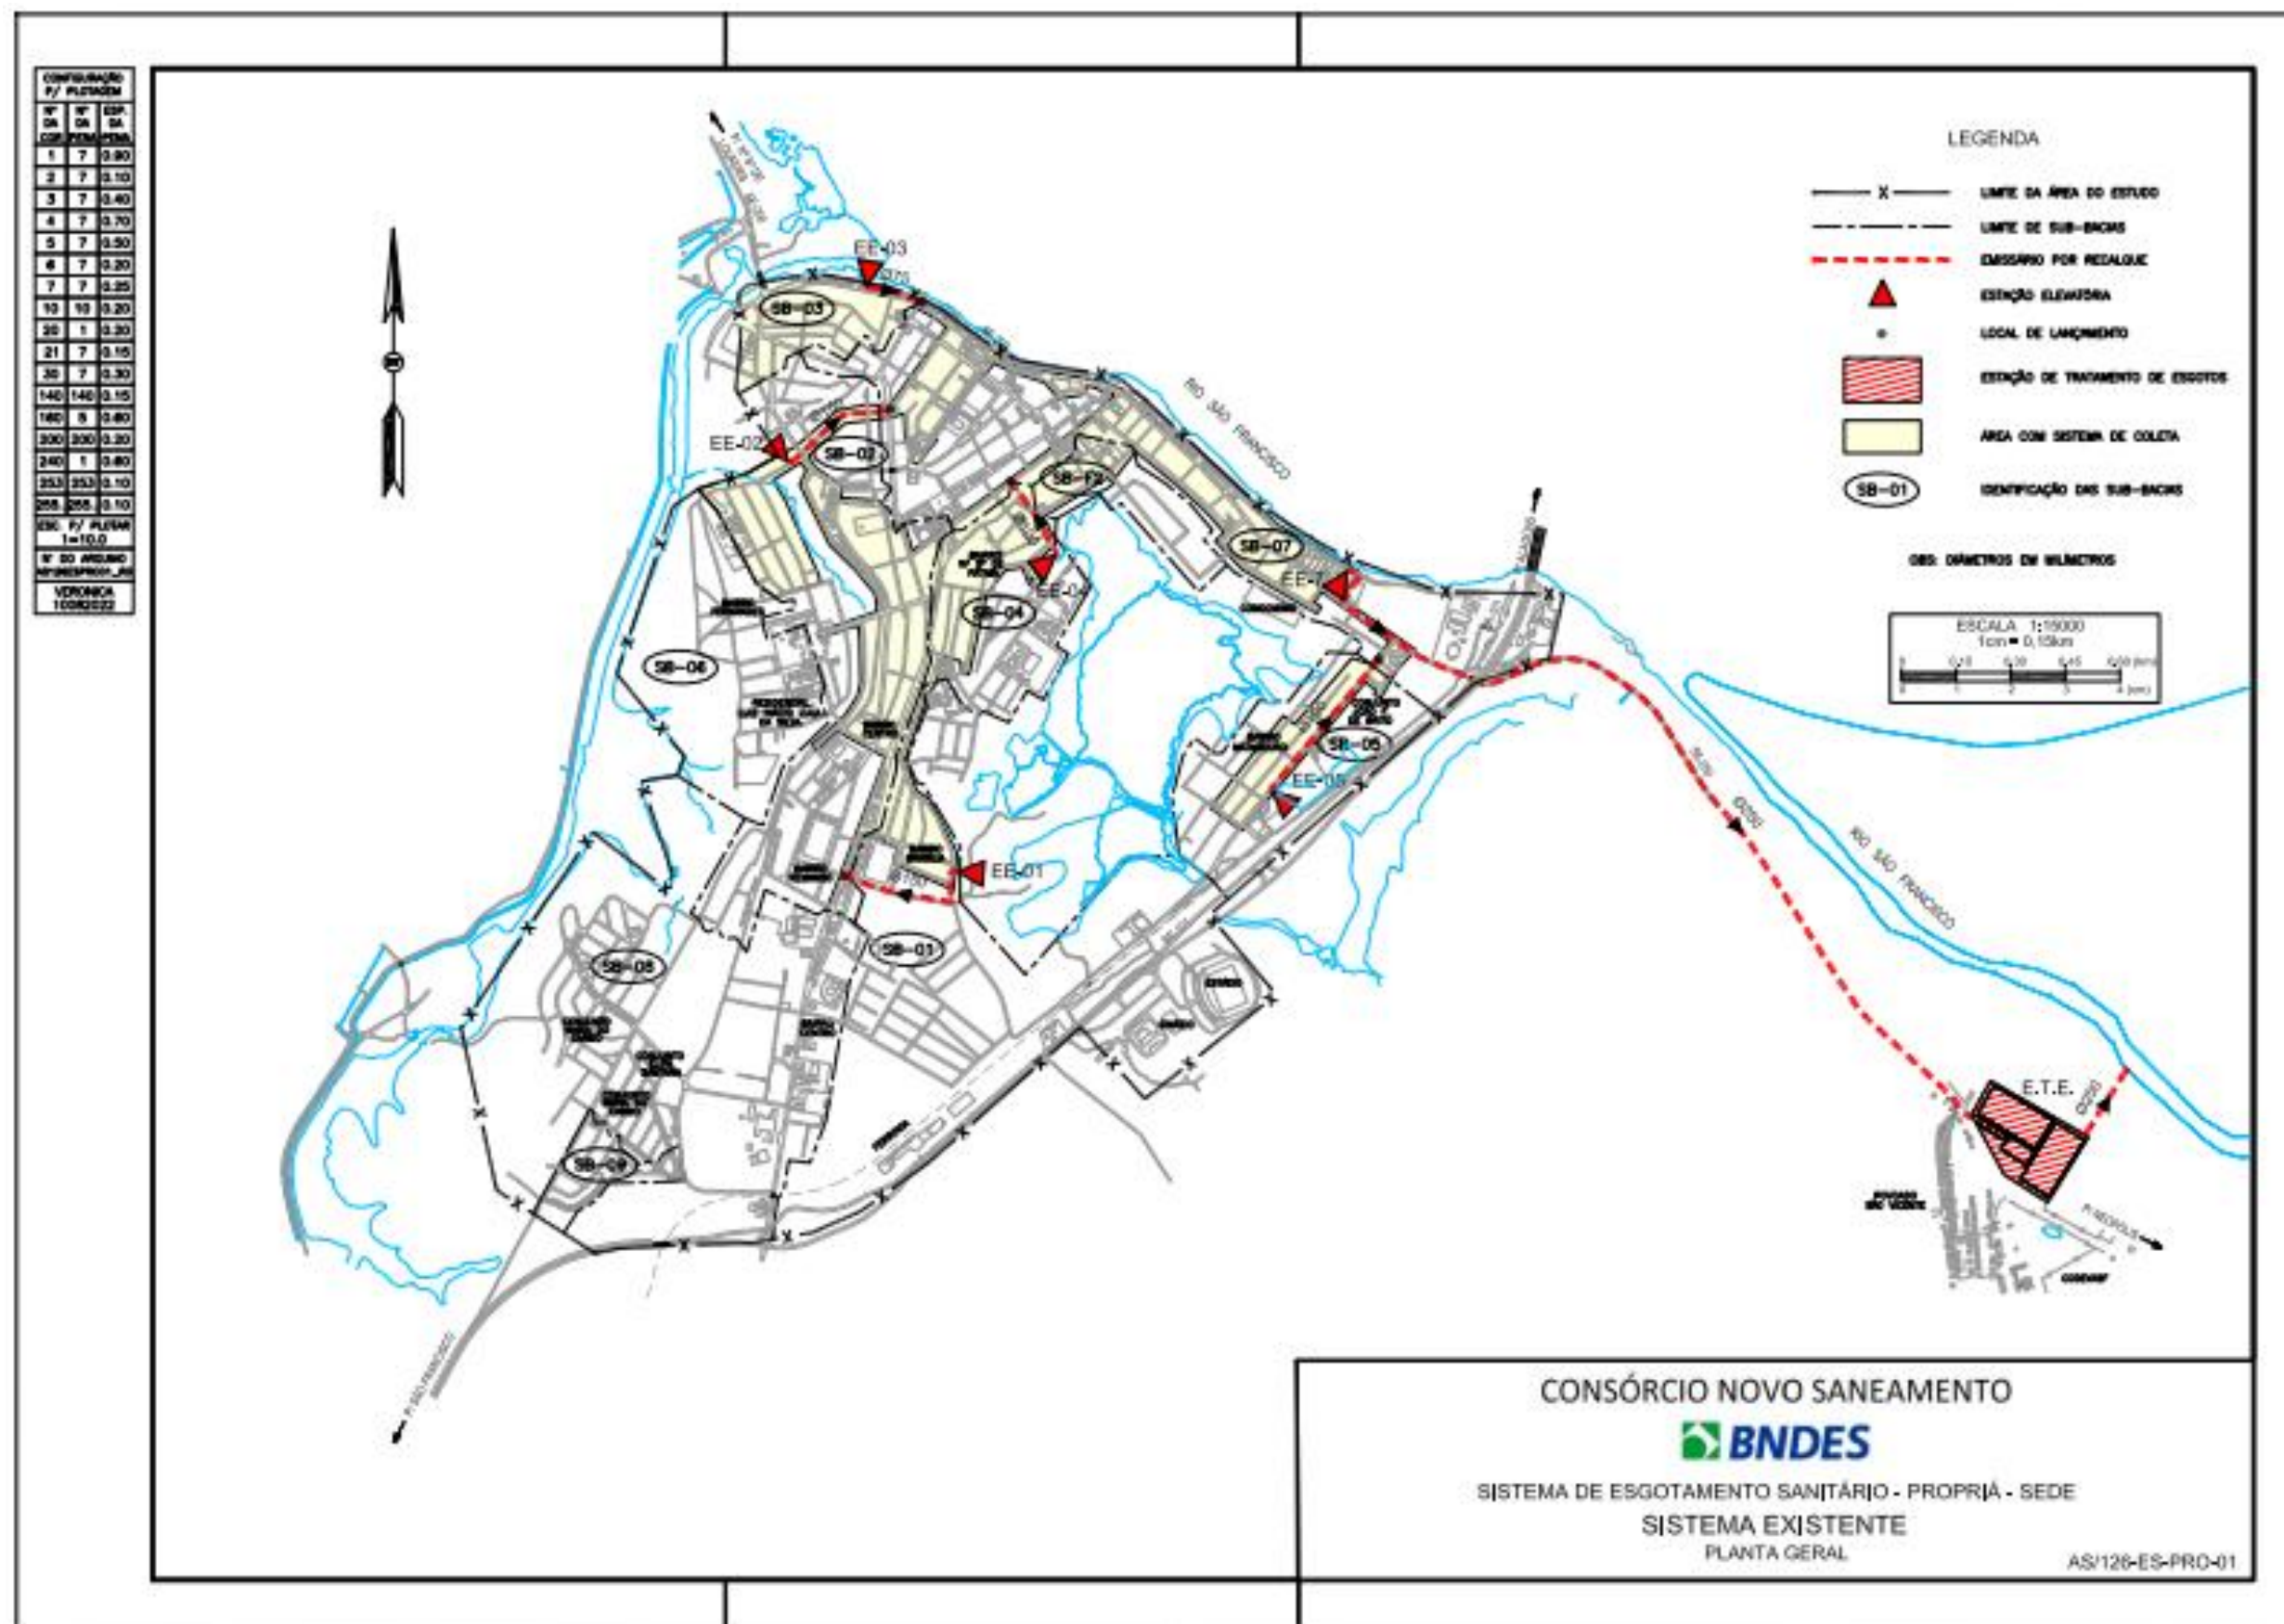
Planta do Sistema de Esgotamento Sanitário – PROPRIA
